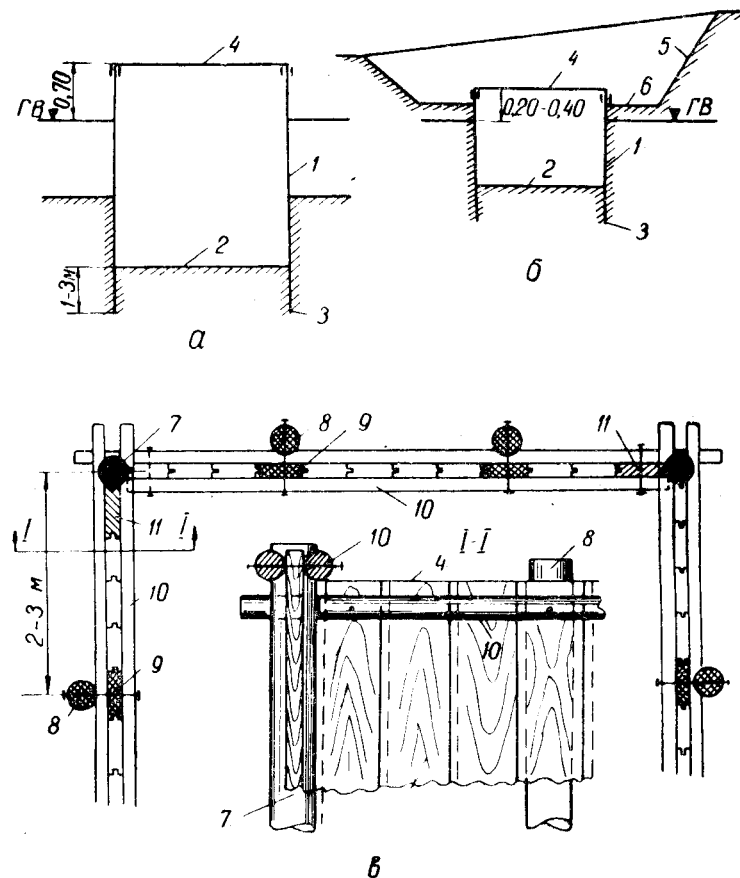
Устройство котлованов с деревянным шпунтовым ограждением: а — котлован в шпунтовом ограждении на местности, покрытой водой; б — котлован на суше, ниже уровня грунтовых вод; в — деталь устройства шпунтового ограждения; 1 — шпунтовое ограждение; 2 — дно котлована; 3 — острие шпунта; 4 — верх шпунтин; 5 — откос котлована (выше уровня грунтовых вод); 6 — берма для производственных целей; 7 — угловая свая (с двумя гребнями); 8 — маячная свая; 9 — маячная шпунтина; 10 — направляющие схватки (обвязка); 11 — закладная шпунтина (с двумя пазами)
